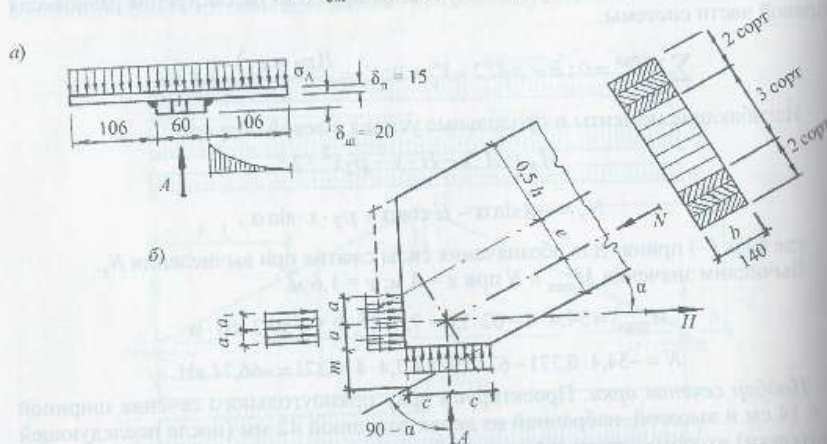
К расчету опорного узла: а — расчетная схема опорной плиты; б — создание эксцентриситета продольного усилия в узле элемента арки путем соответствующего расположения опорных площадок
